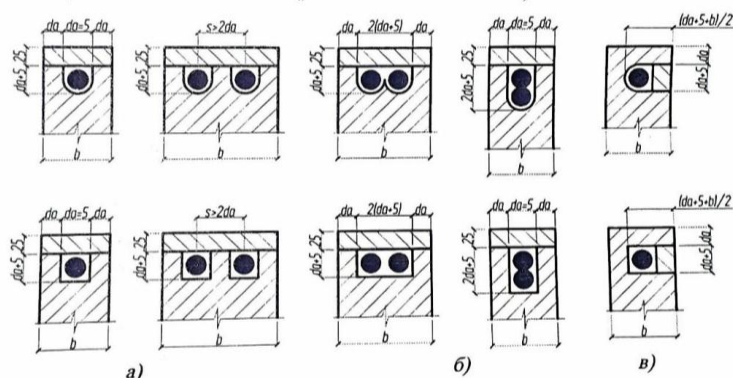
Схема размещения стержней по поперечному сечению балок: индивидуальное размещение а-стержней; б-сложение одинаковых стержней вместе; в - размещение таких же стержней вдоль боковых поверхностей сечения балки.
